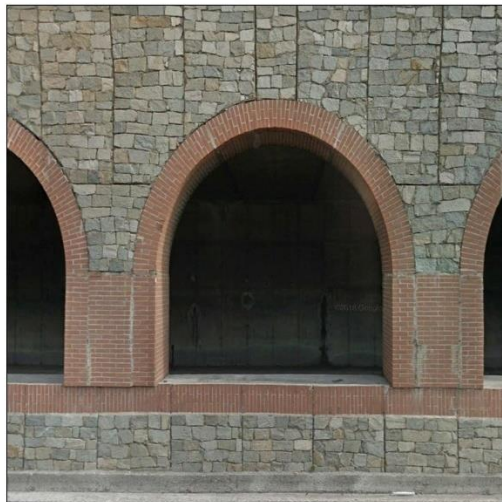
Rivestimento muri galleria artificiale esistente, muri a secco e parapetti su strade secondarie (fonte – elaborato 110722-LL02-PE-A3-G12-GP12W-0-D-AUA1516-1)
